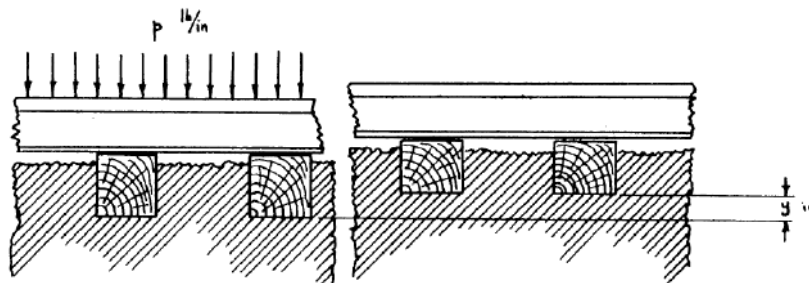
Deflexão no pavimento por carregamento uniformemente distribuído
